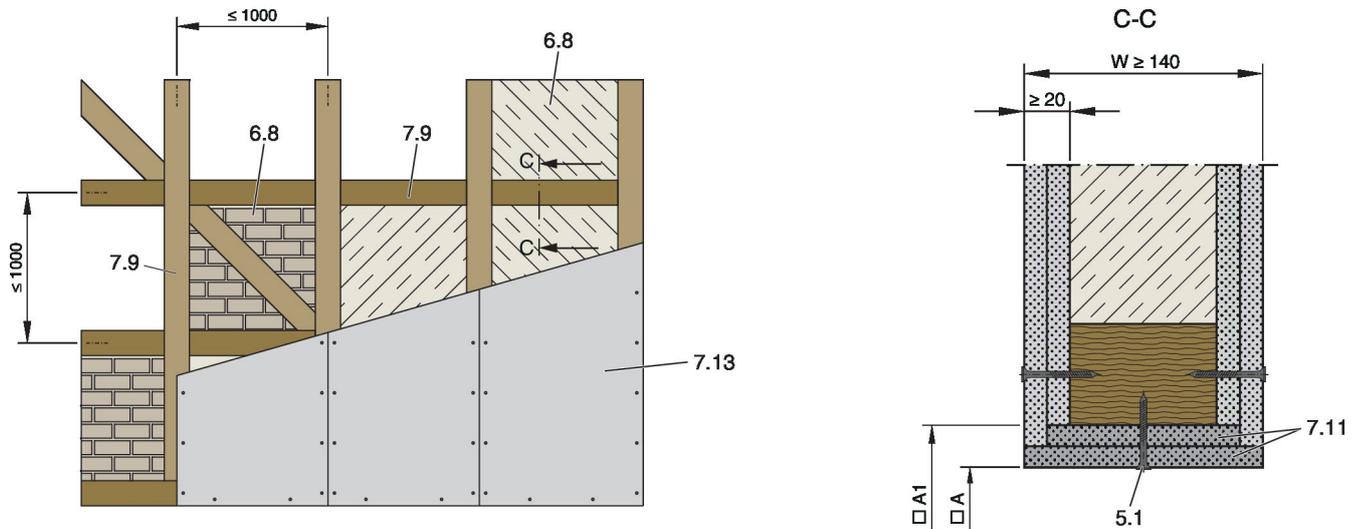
Leichtbauwand mit Holzfachwerk und beidseitiger Beplankung
